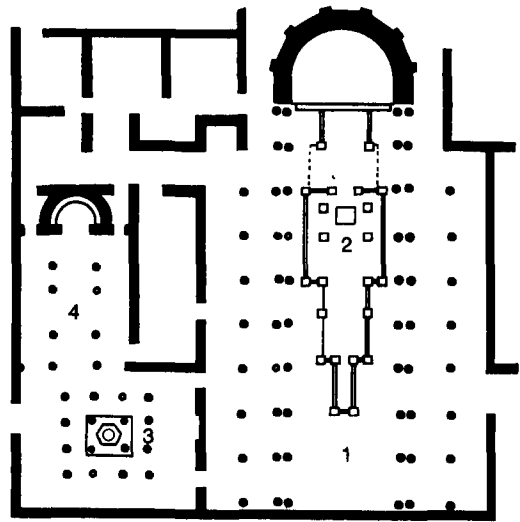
Grundriss der Basilika Dermech I. Nach Elliger aO. Abb. 30.
